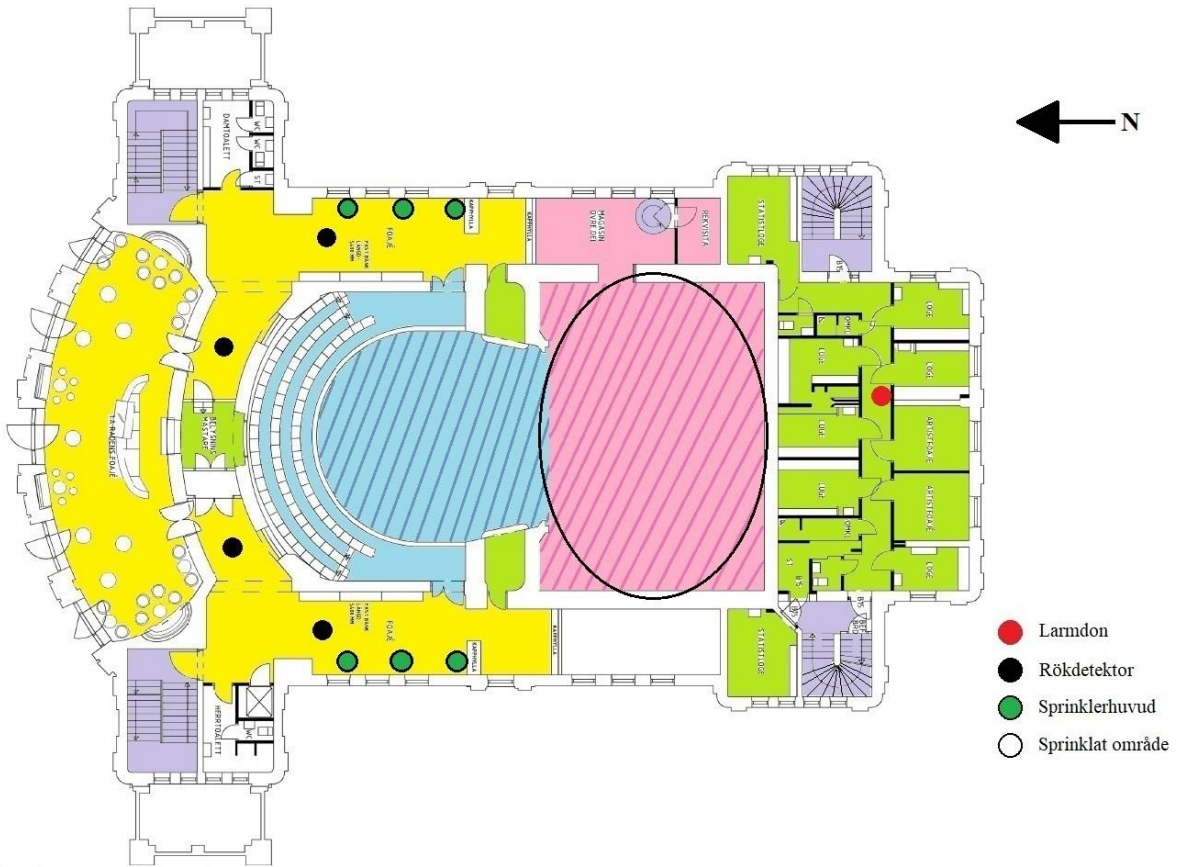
Plan 1: larm- och detektionssystem samt sprinklat område.
